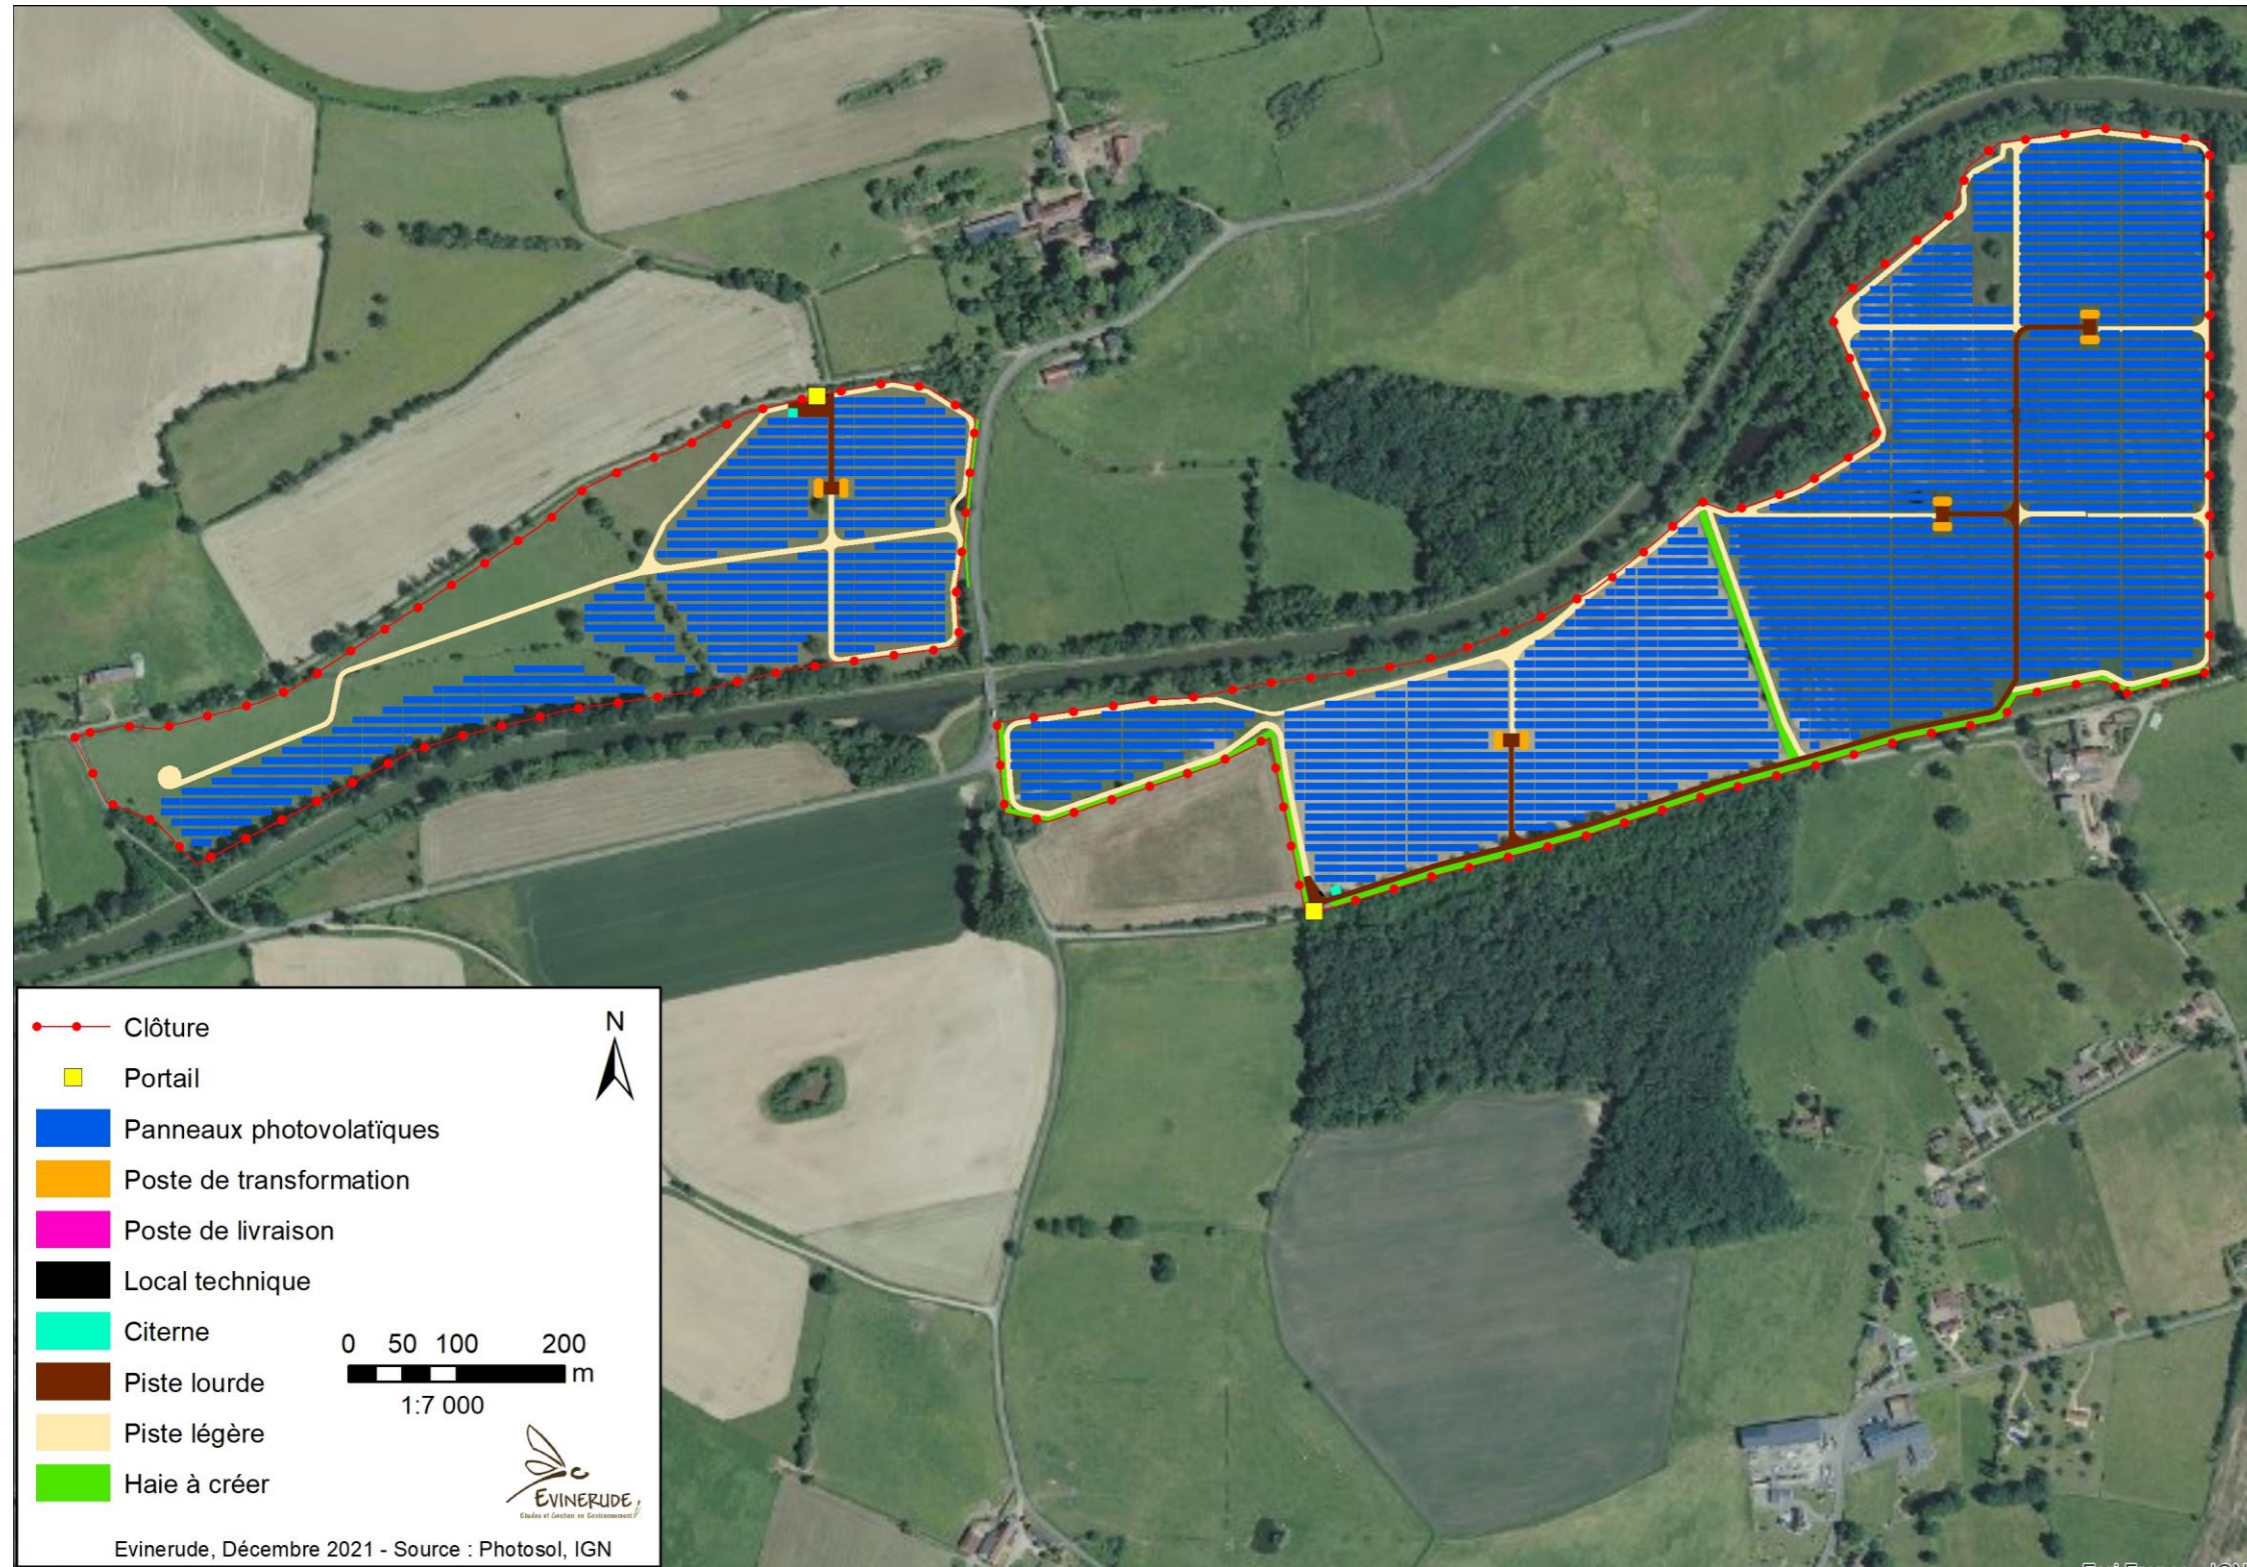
Plan d'implantation du projet-îlots Est et Ouest
